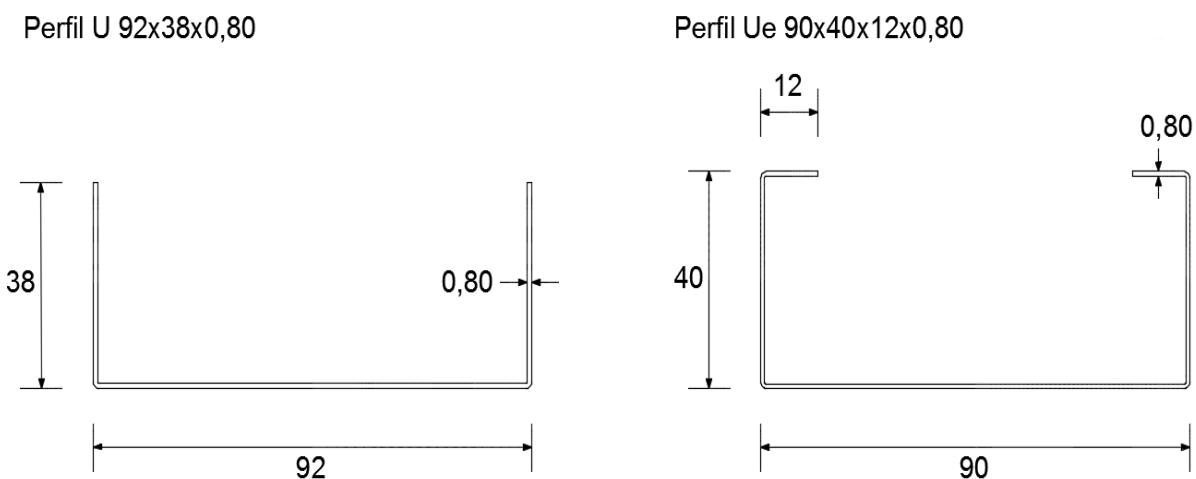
Perfis U 92x38x0,80 e Ue 90x40x12x0,80, dimensões em mm
